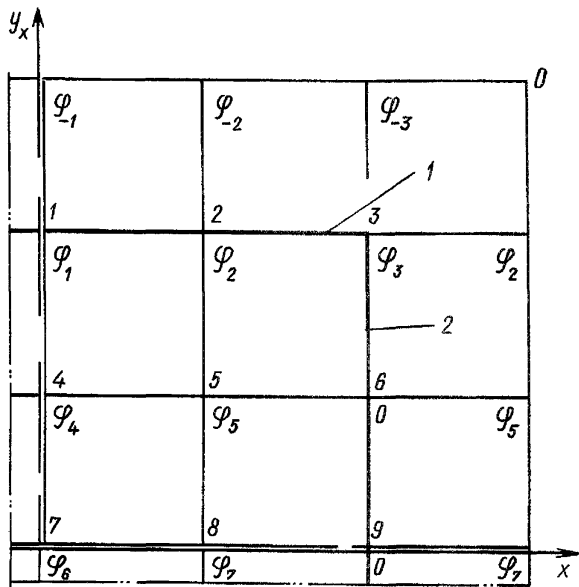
Расчетная схема железобетонной плиты:
